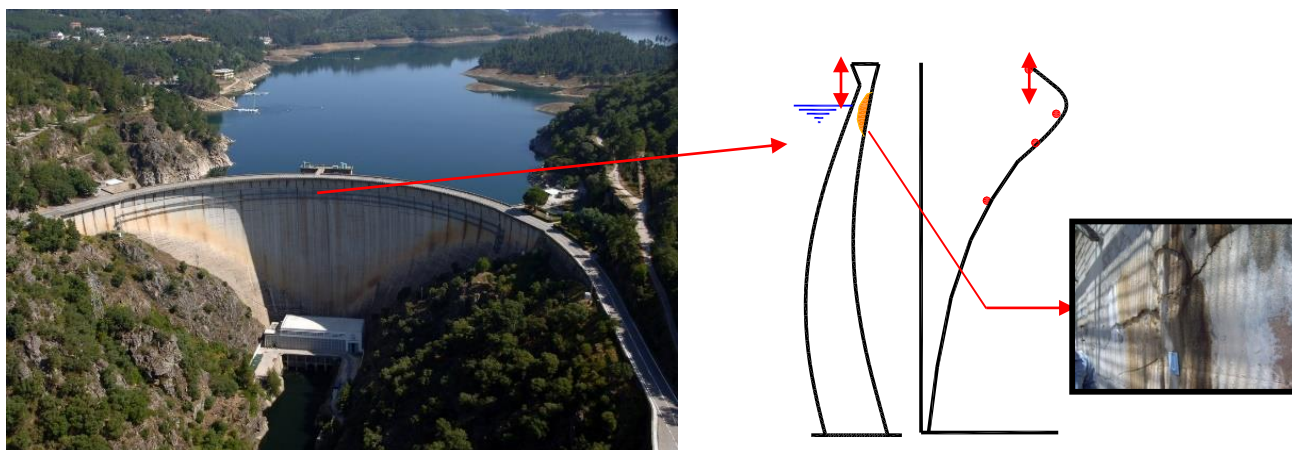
Barragem do Cabril. Vista e corte pela consola central. Pormenor da fendilhação horizontal.
